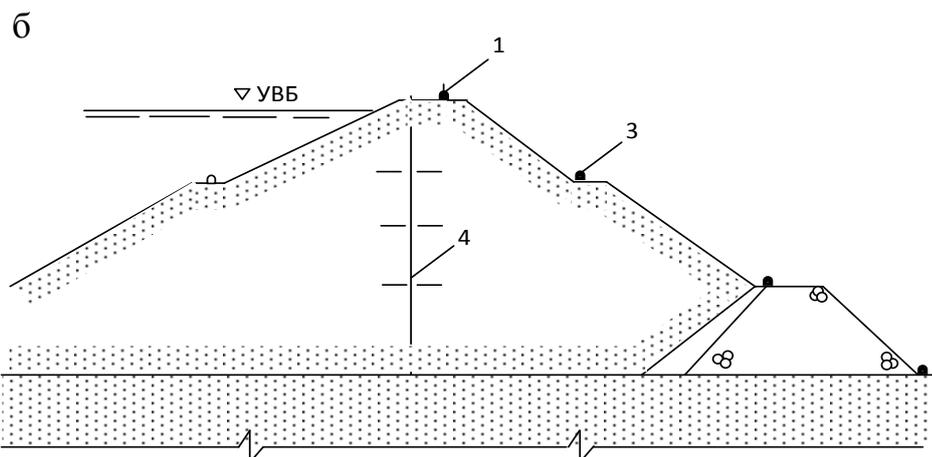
Принципиальные схемы размещения геодезических марок на грунтовых плотинах:
